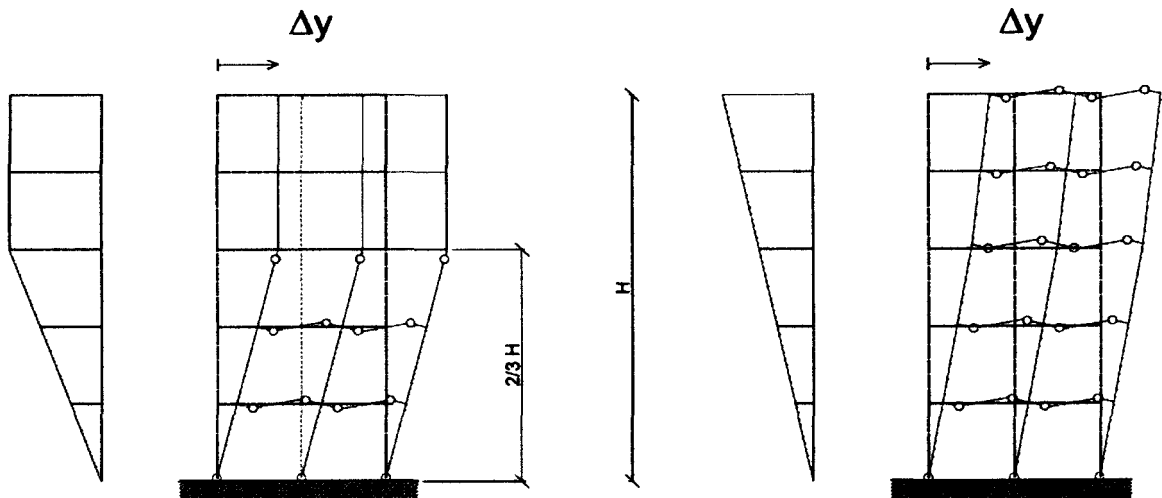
Mecanismos de Colapsos del Pórtico de Hormigón Armado Sismorresistente
